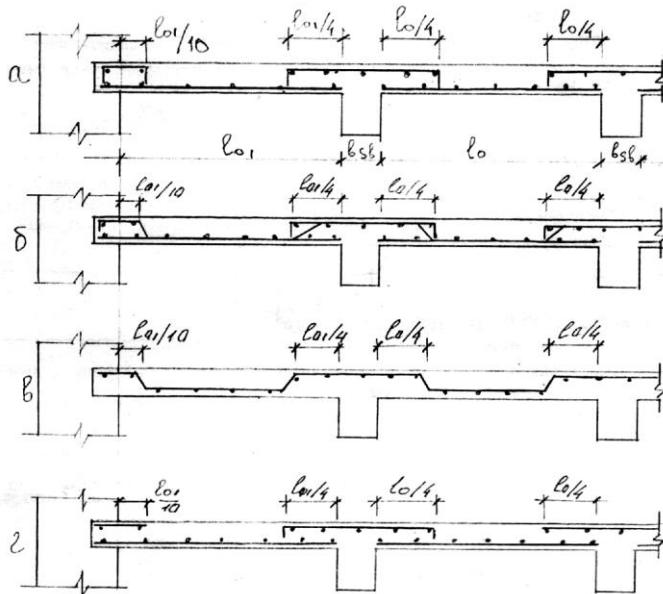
Армування монолітних плит: а, б – окремими стержнями; в, г – зварними сітками
